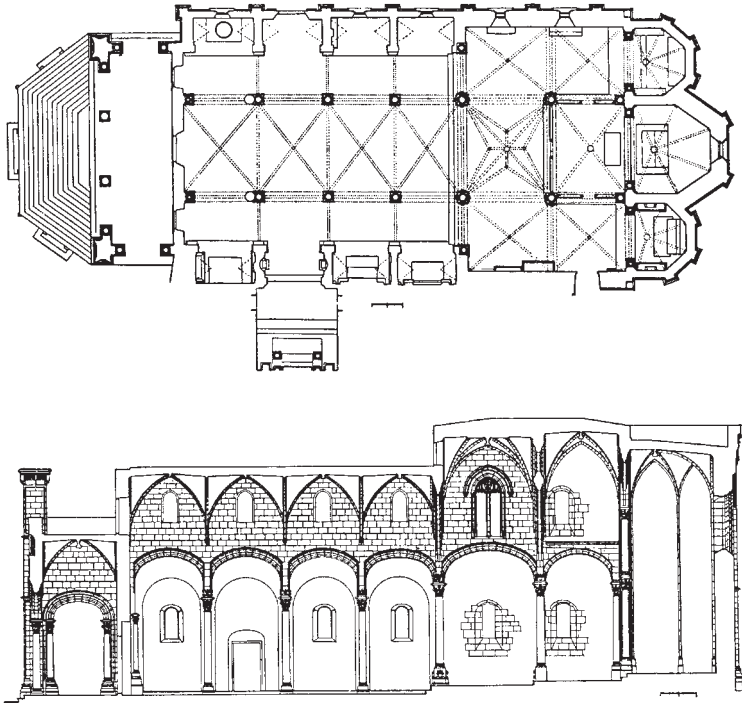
Palermo, chiesa della Catena, pianta e sezione (da F. Meli).
